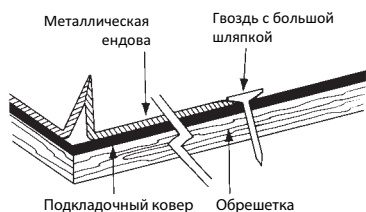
Крепление металлической гидроизоляции ендовы гвоздями с большой шляпкой.
